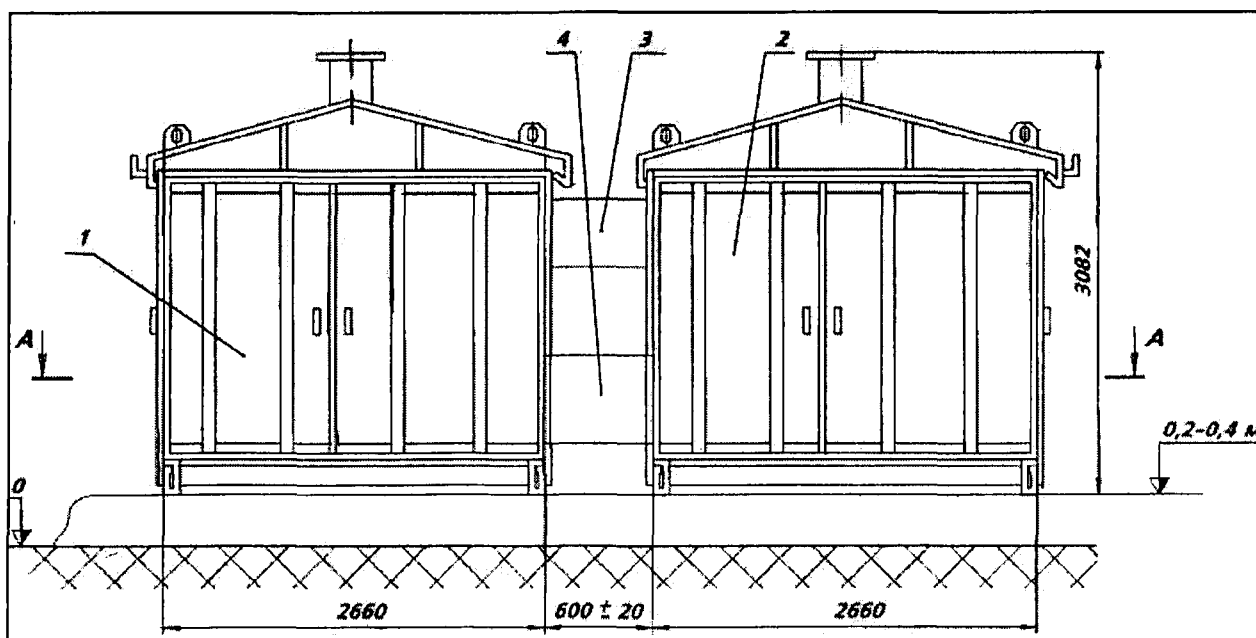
Общий вид, габаритные и установочные размеры однолучевой двухтрансформаторной 2КТП-СЭЩ®-Г (вариант с кабельными вводами ВН)
